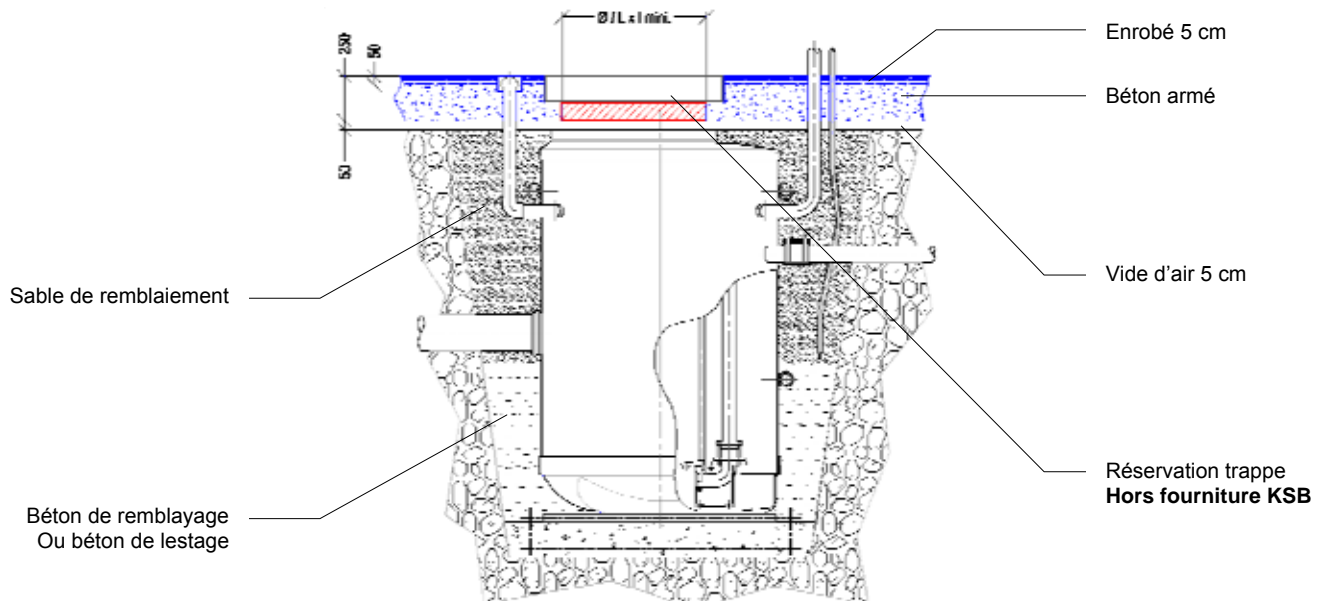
Dalle de répartition en béton armé pour installation sous chaussée
